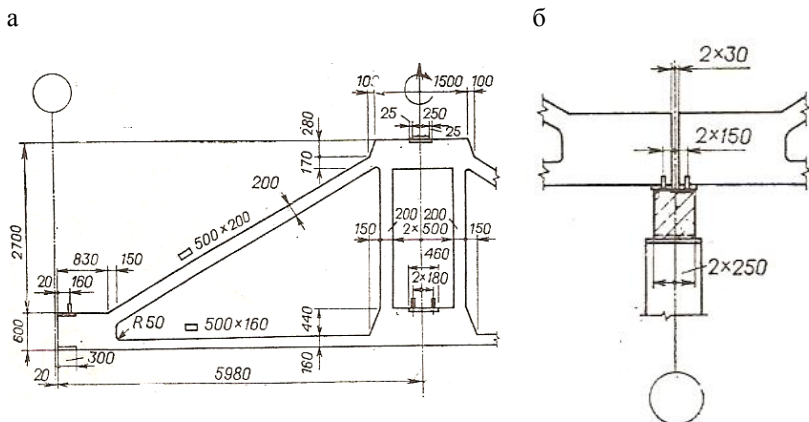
Подстропильная железобетонная ферма для малоуклонных покрытий:
